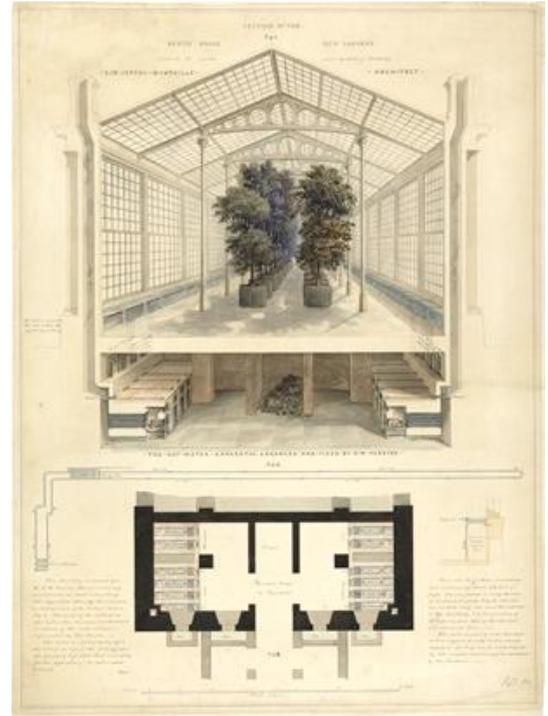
Proyecto de Jeffry Wyattville para la nueva Palm House de Kew Gardens, 1836.
